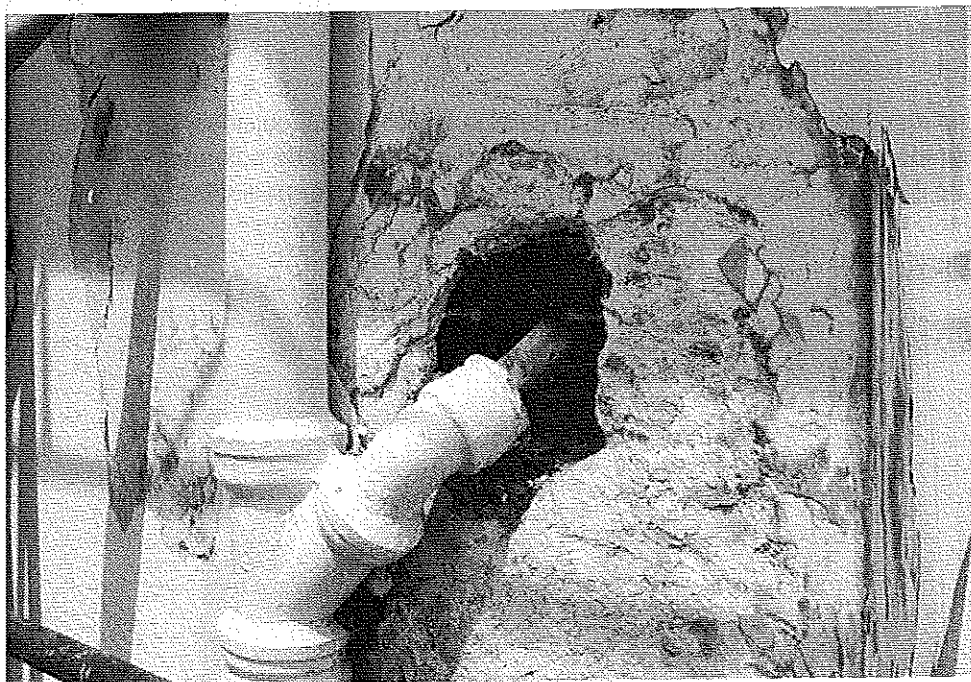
Raccordement dans l'épaisseur du mur d'un raccord fonte (coude 1/8) avec tuyau plomb. © J. Putatti
